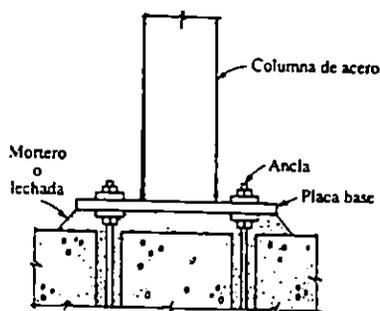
Placa Base de columna con inyección de lechada y tornillos de anclaje embebidos
